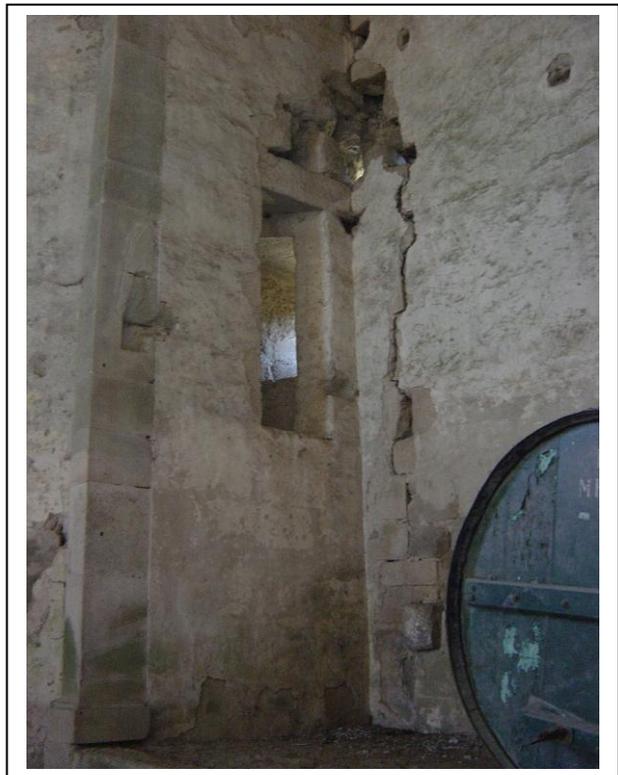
Fissura na parede da capela-mor. Foto da autora.
